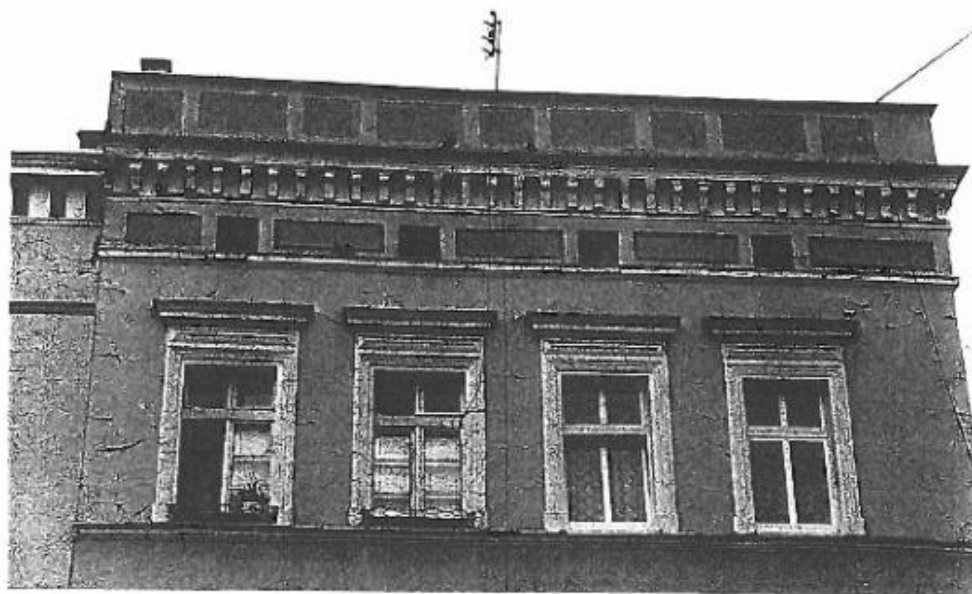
/10. Kamienica Rynek 1, elewacja południowa (widok od południowego-zachodu).
